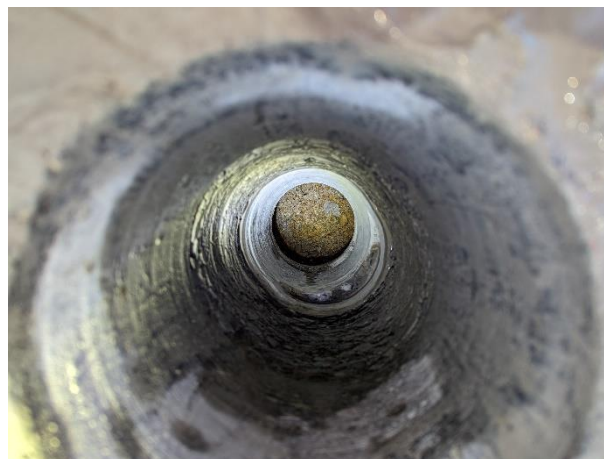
Remblai observé sous la dalle de transition, un espace entre le remblai et la dalle de transition est constaté
